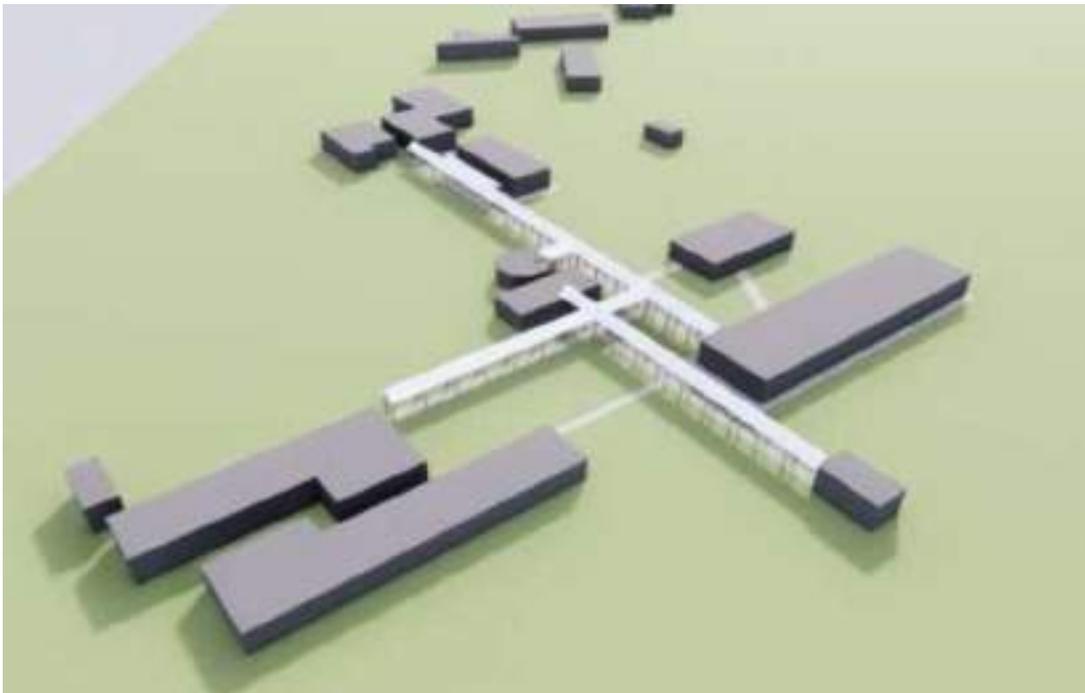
Imagen Tridimensional. Cubierta Pasillos Vista Norte (Color Blanco).
